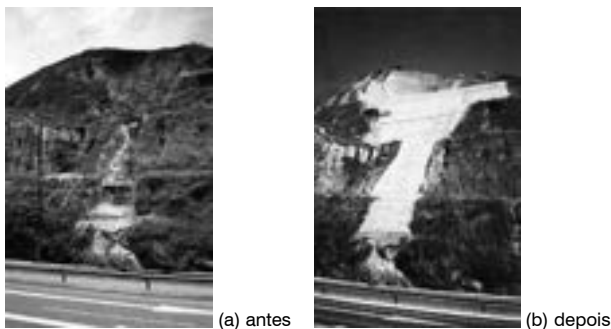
Preenchimento de área erodida com solo-cimento ensacado (Coutinho et al, 2008)
